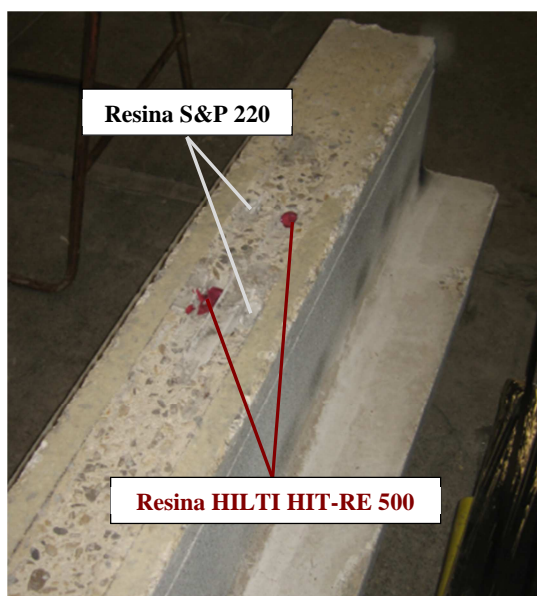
Aspecto final dos furos preenchidos com as resinas utilizadas
